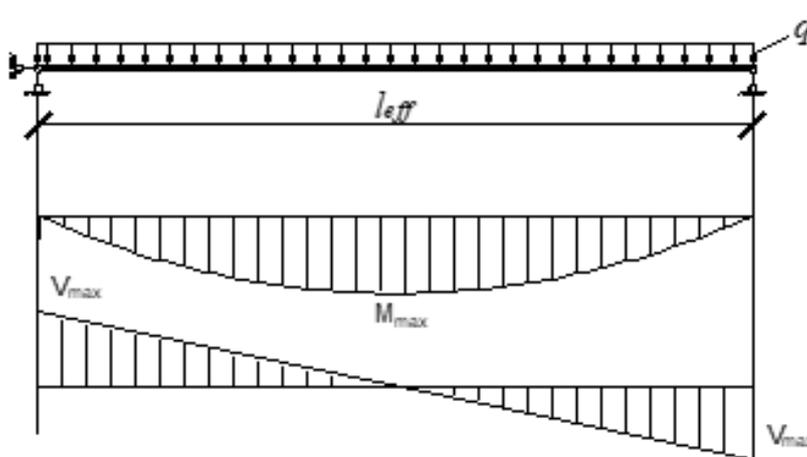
Розрахункова схема плити та епюри згинальних моментів і поперечних сил
